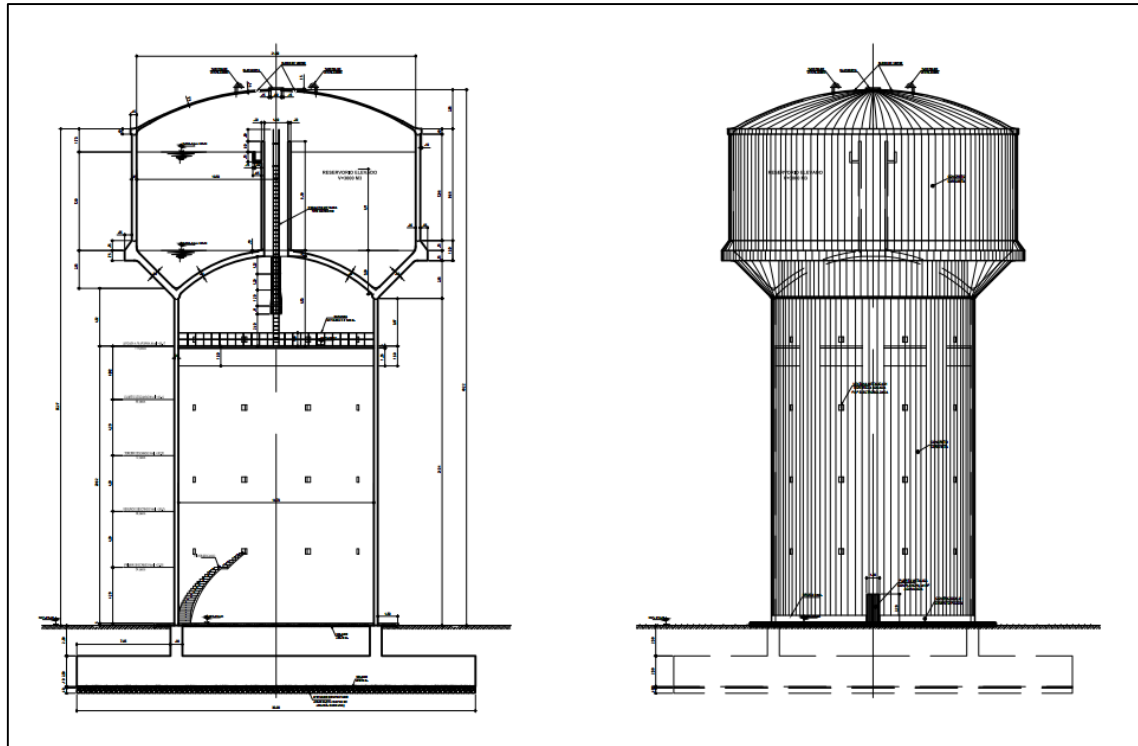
Plano de corte y elevación del reservorio elevado proyectado Cercado de Sechura de 3000 m³
